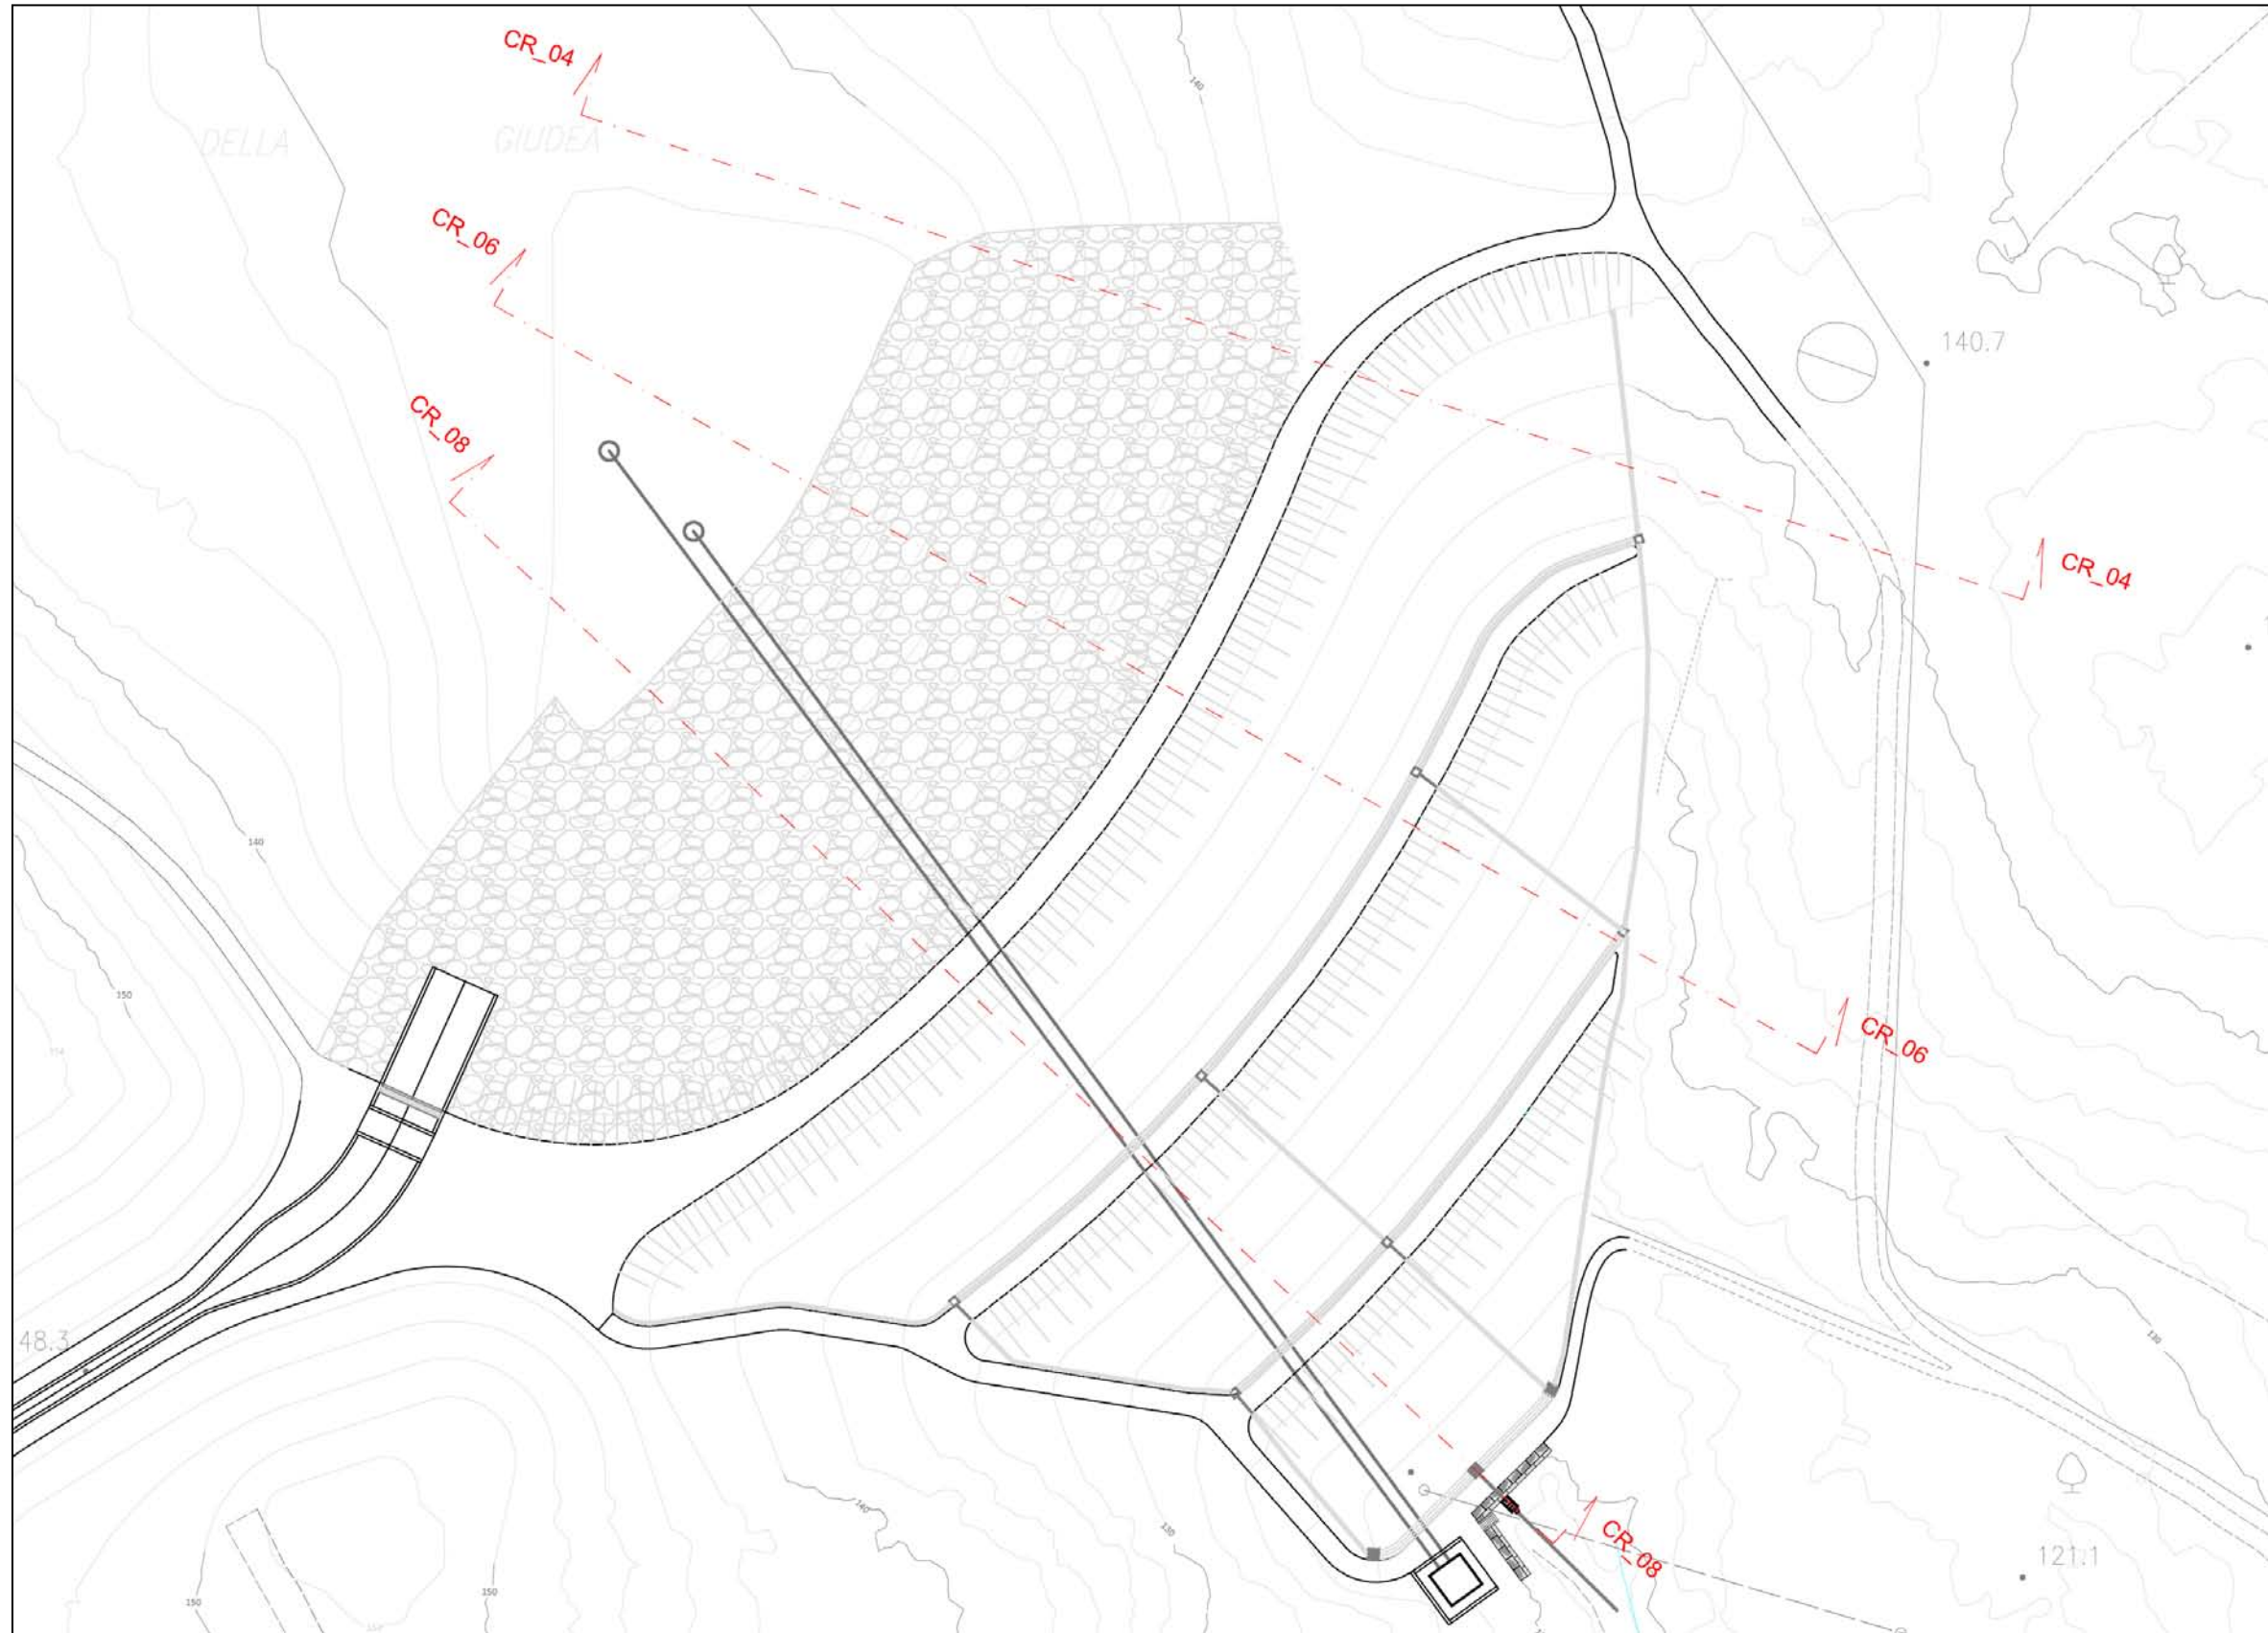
Planimetria sezioni di verifica (scala 1:1'000)
